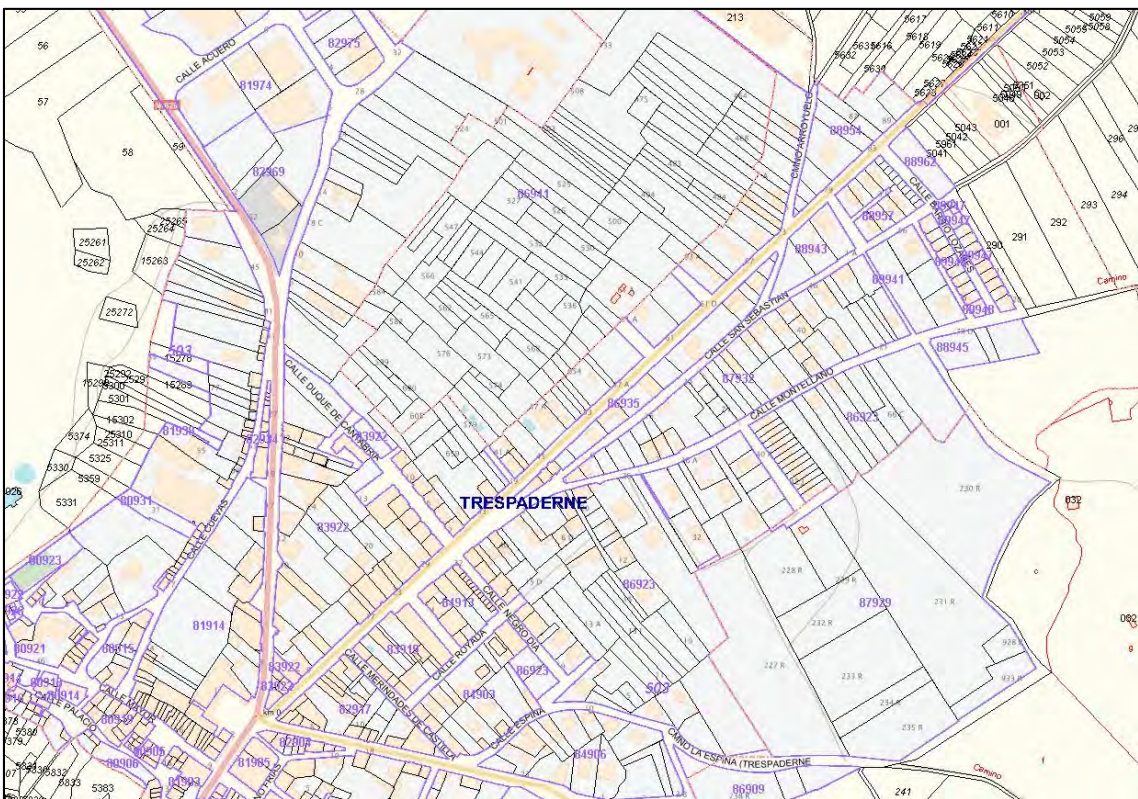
Planta de travesía de carretera BU-55 sobre fondo catastral.
